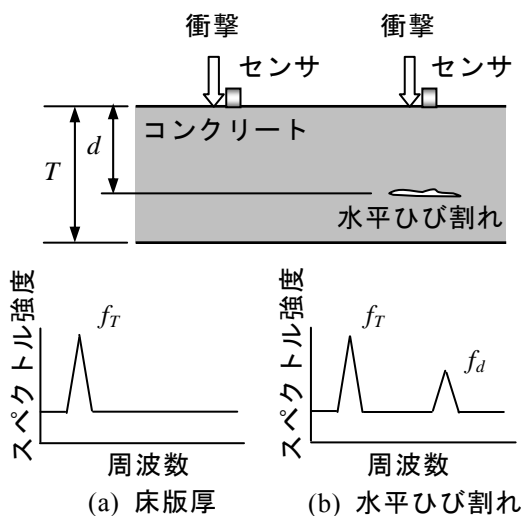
衝撃弾性波法による水平ひび割れの検出原理
